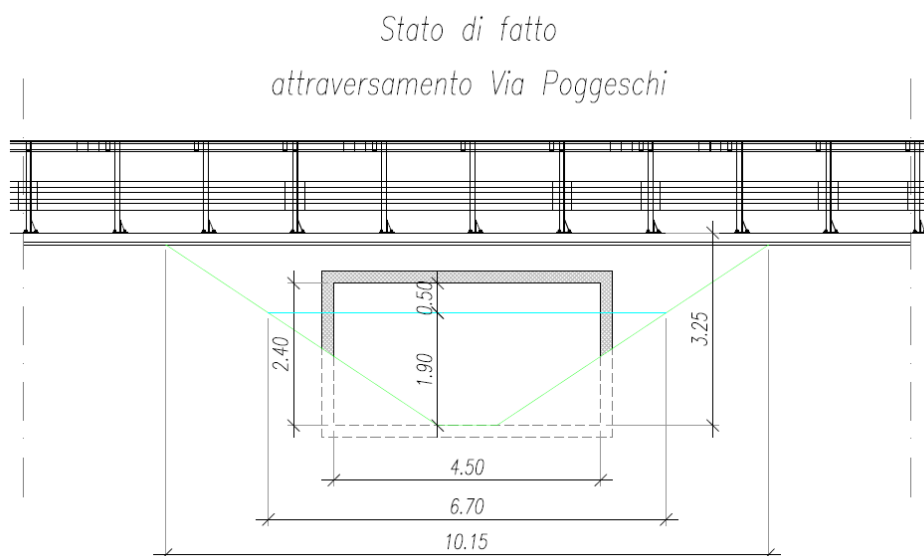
Sezione attraversamento Via Poggeschi
